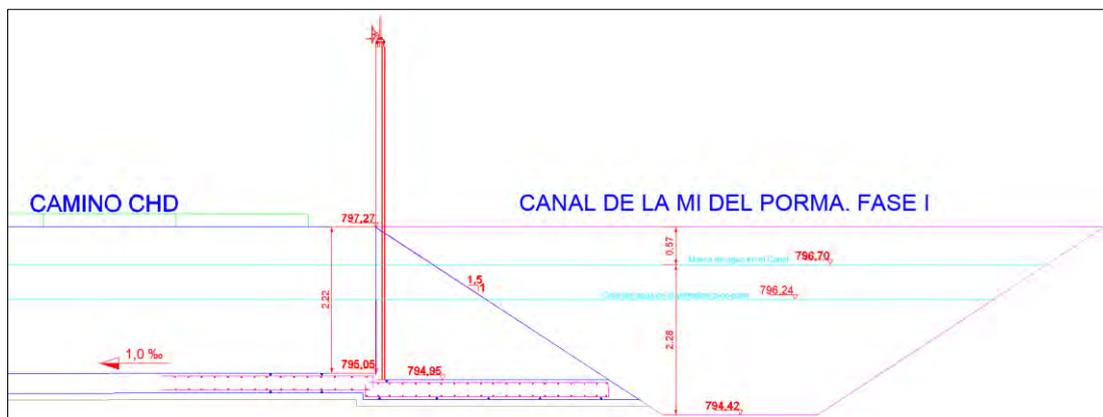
Vista en sección de la compuerta y canal de abastecimiento a balsa del sector III.
